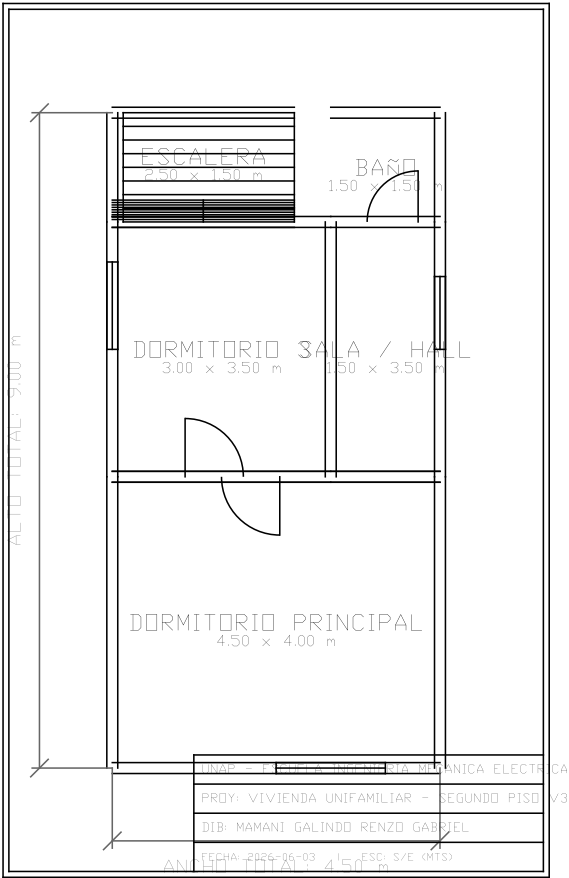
Plano de Distribución Arquitectónica - Segundo Piso
